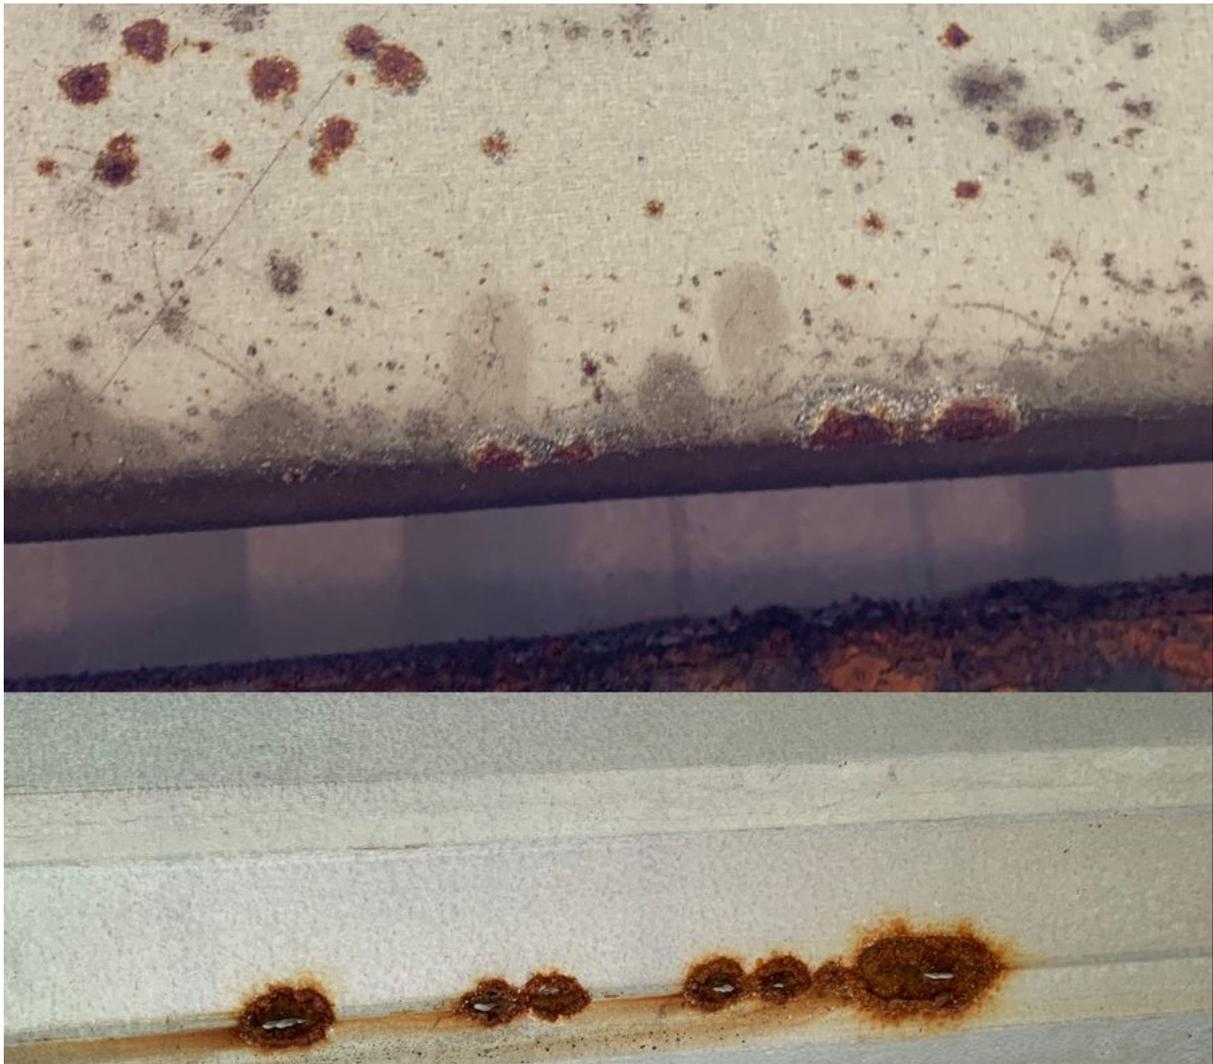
Corrosão galvânica entre telha de zinco e perfil metálico.
